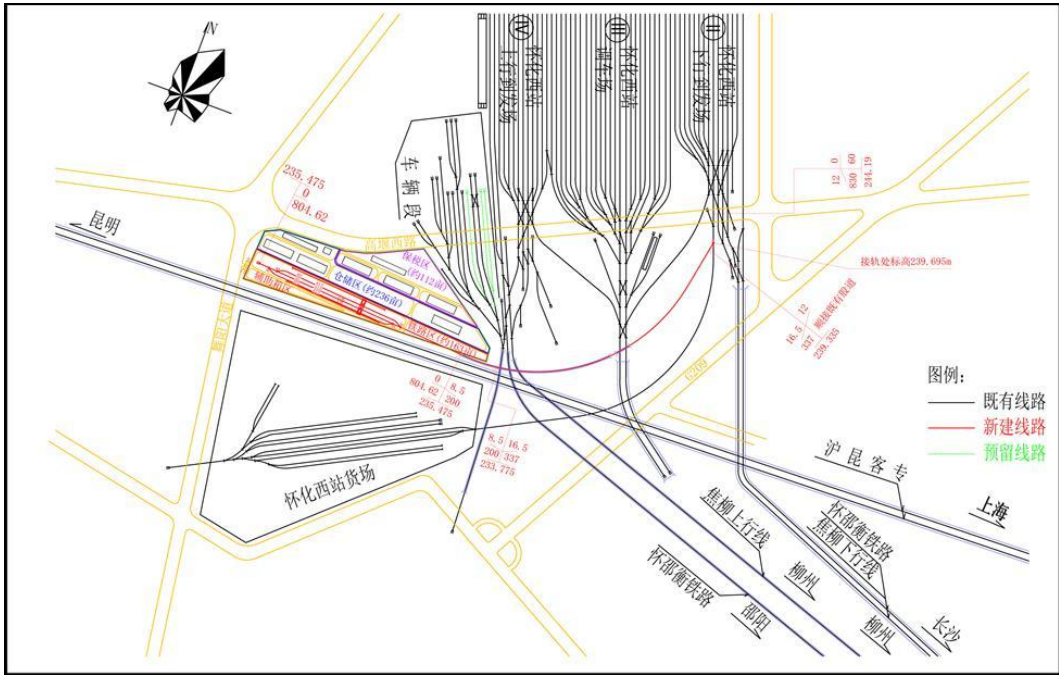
专用线从下行到发场南端咽喉接轨方案（方案 II）平面布置示意图
